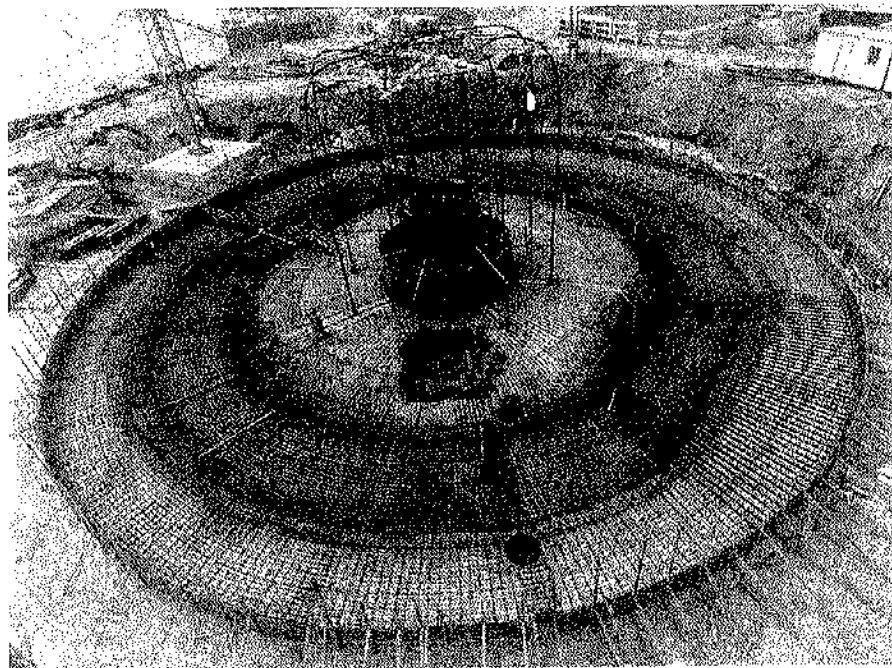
Vista aérea de la losa de cimentación y el pretensado de los pilares interiores.
